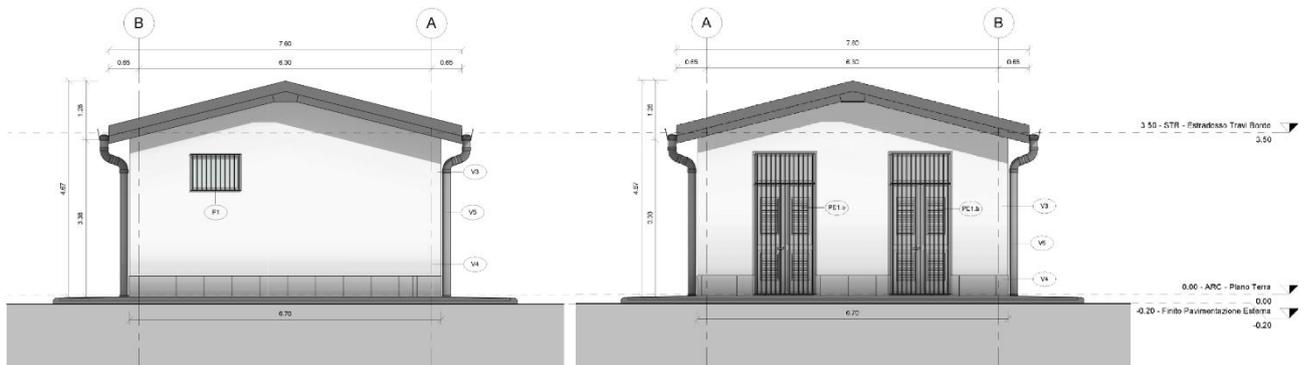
GA Nord – Prospetti Nord e Sud
